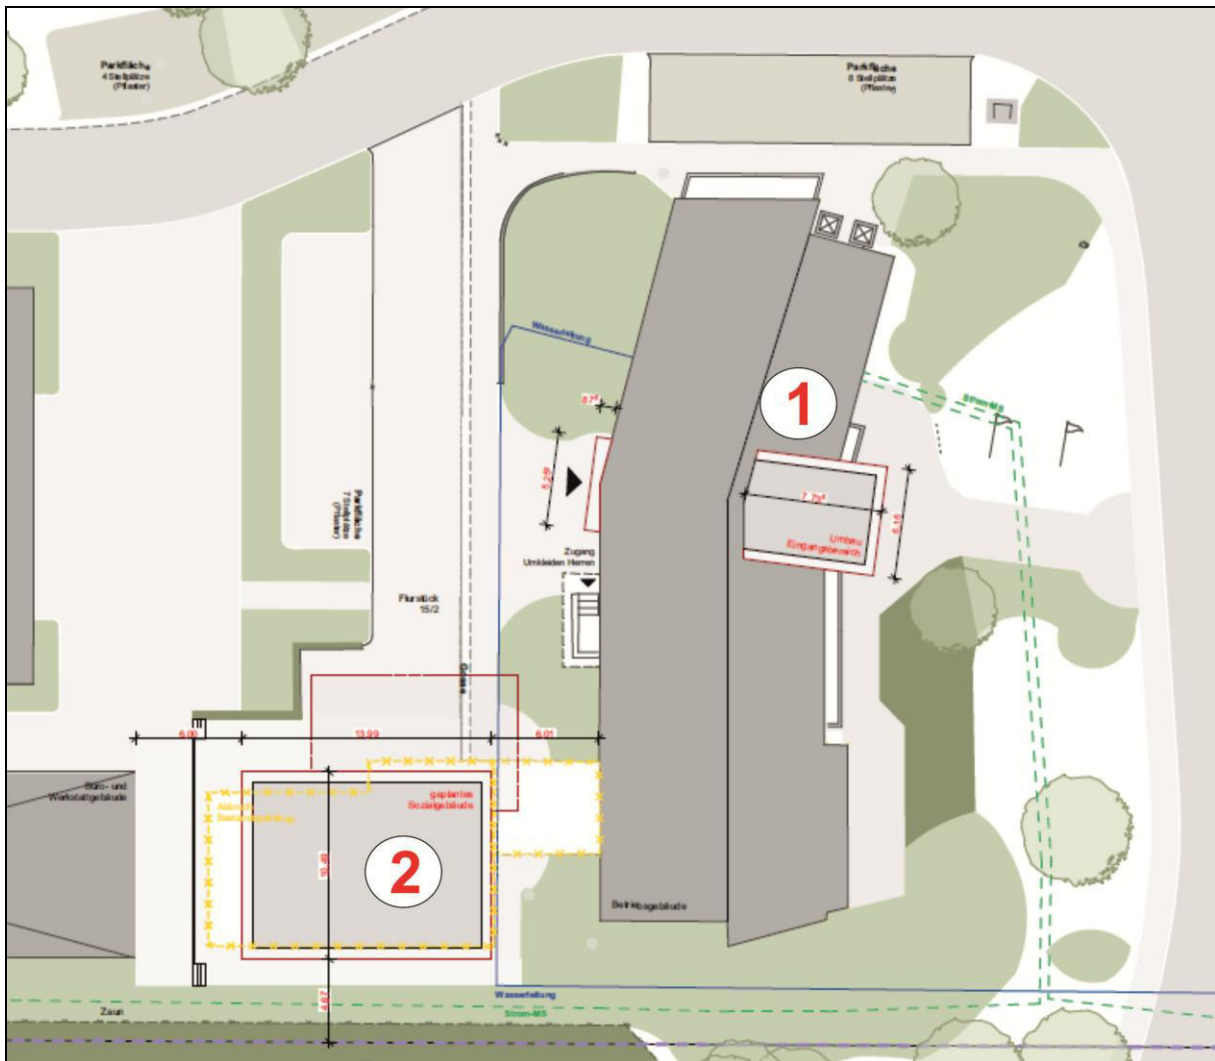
Geplante Baubereiche: Bereich 1 -Umbau Betriebsgebäude- / -Bereich 2 Neubau Sozialgebäude-
